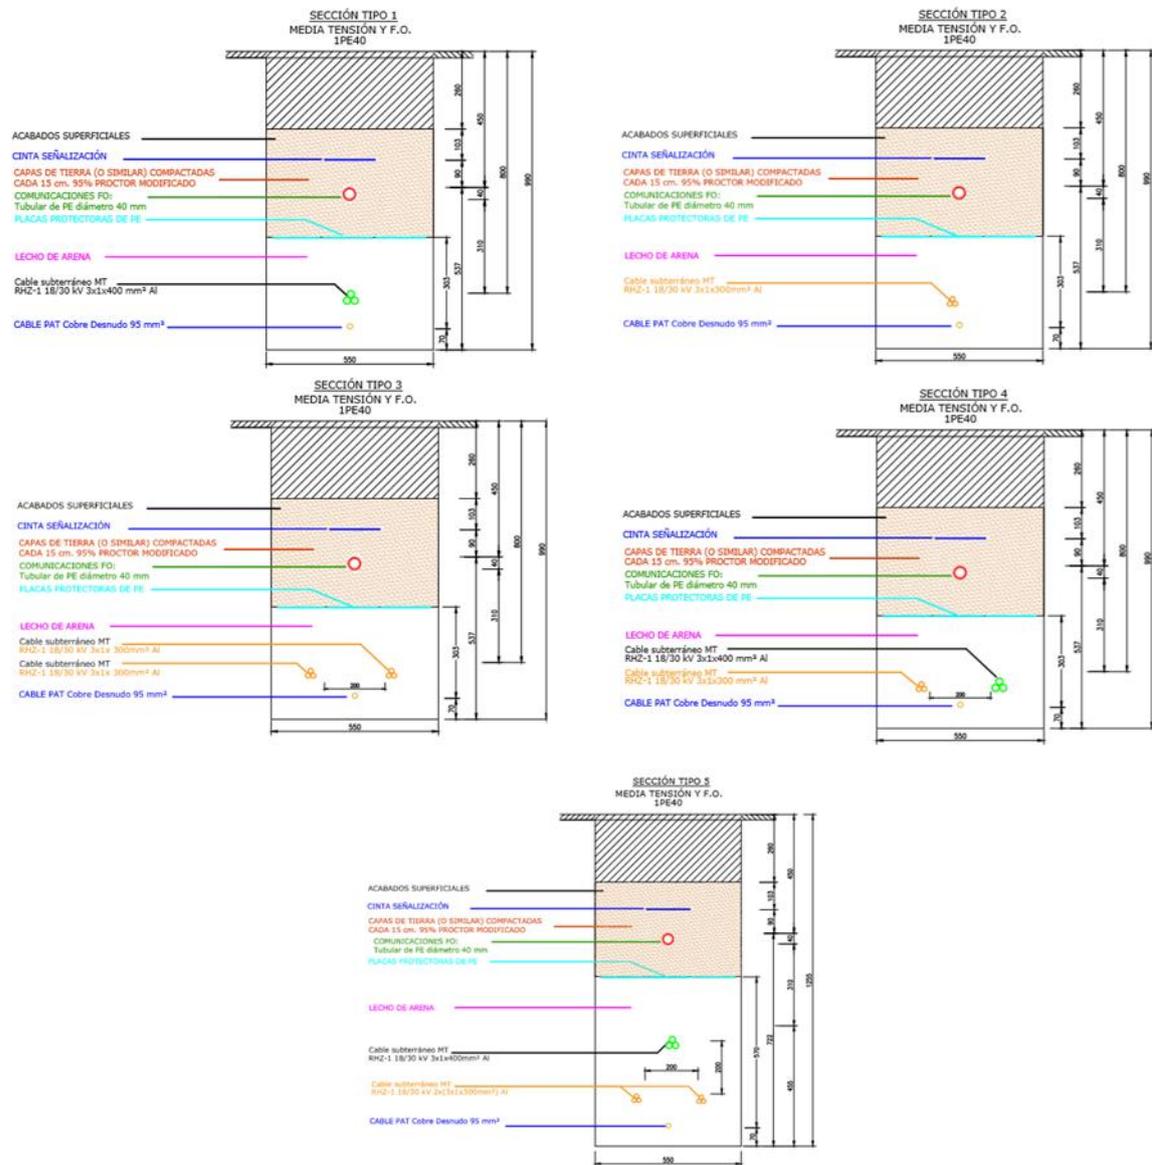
Secciones tipo zanjas MT directamente enterrado
